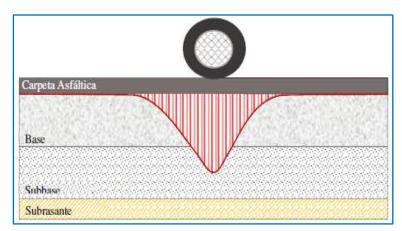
Estructura y distribución de cargas en pavimento flexible Fuente: Espinoza & Vargas, 2020
